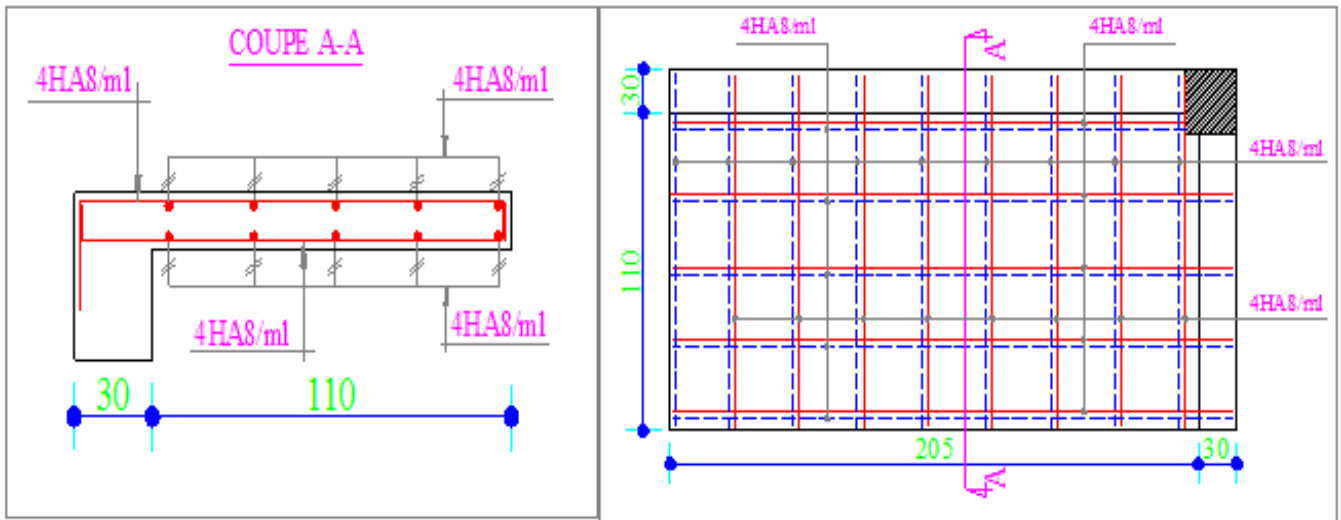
Ferrailage de la dalle sur deux appuis
